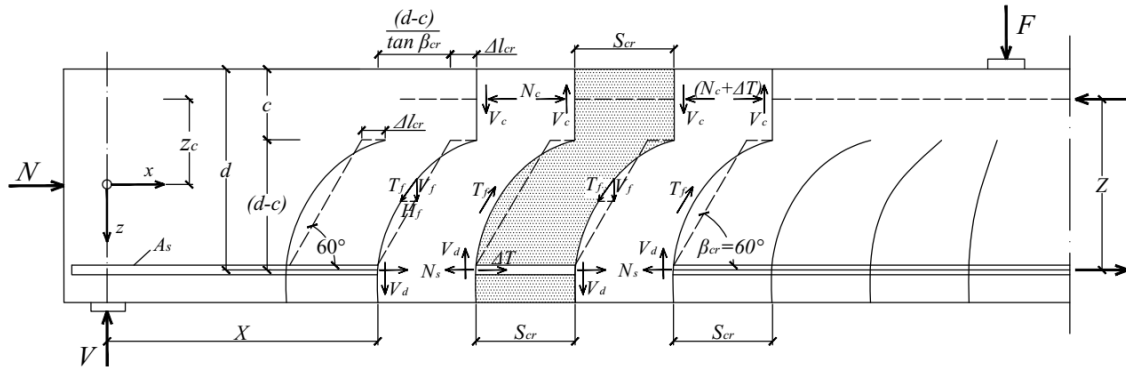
Железобетонная конструкция с «зубчатыми» элементами [1]
